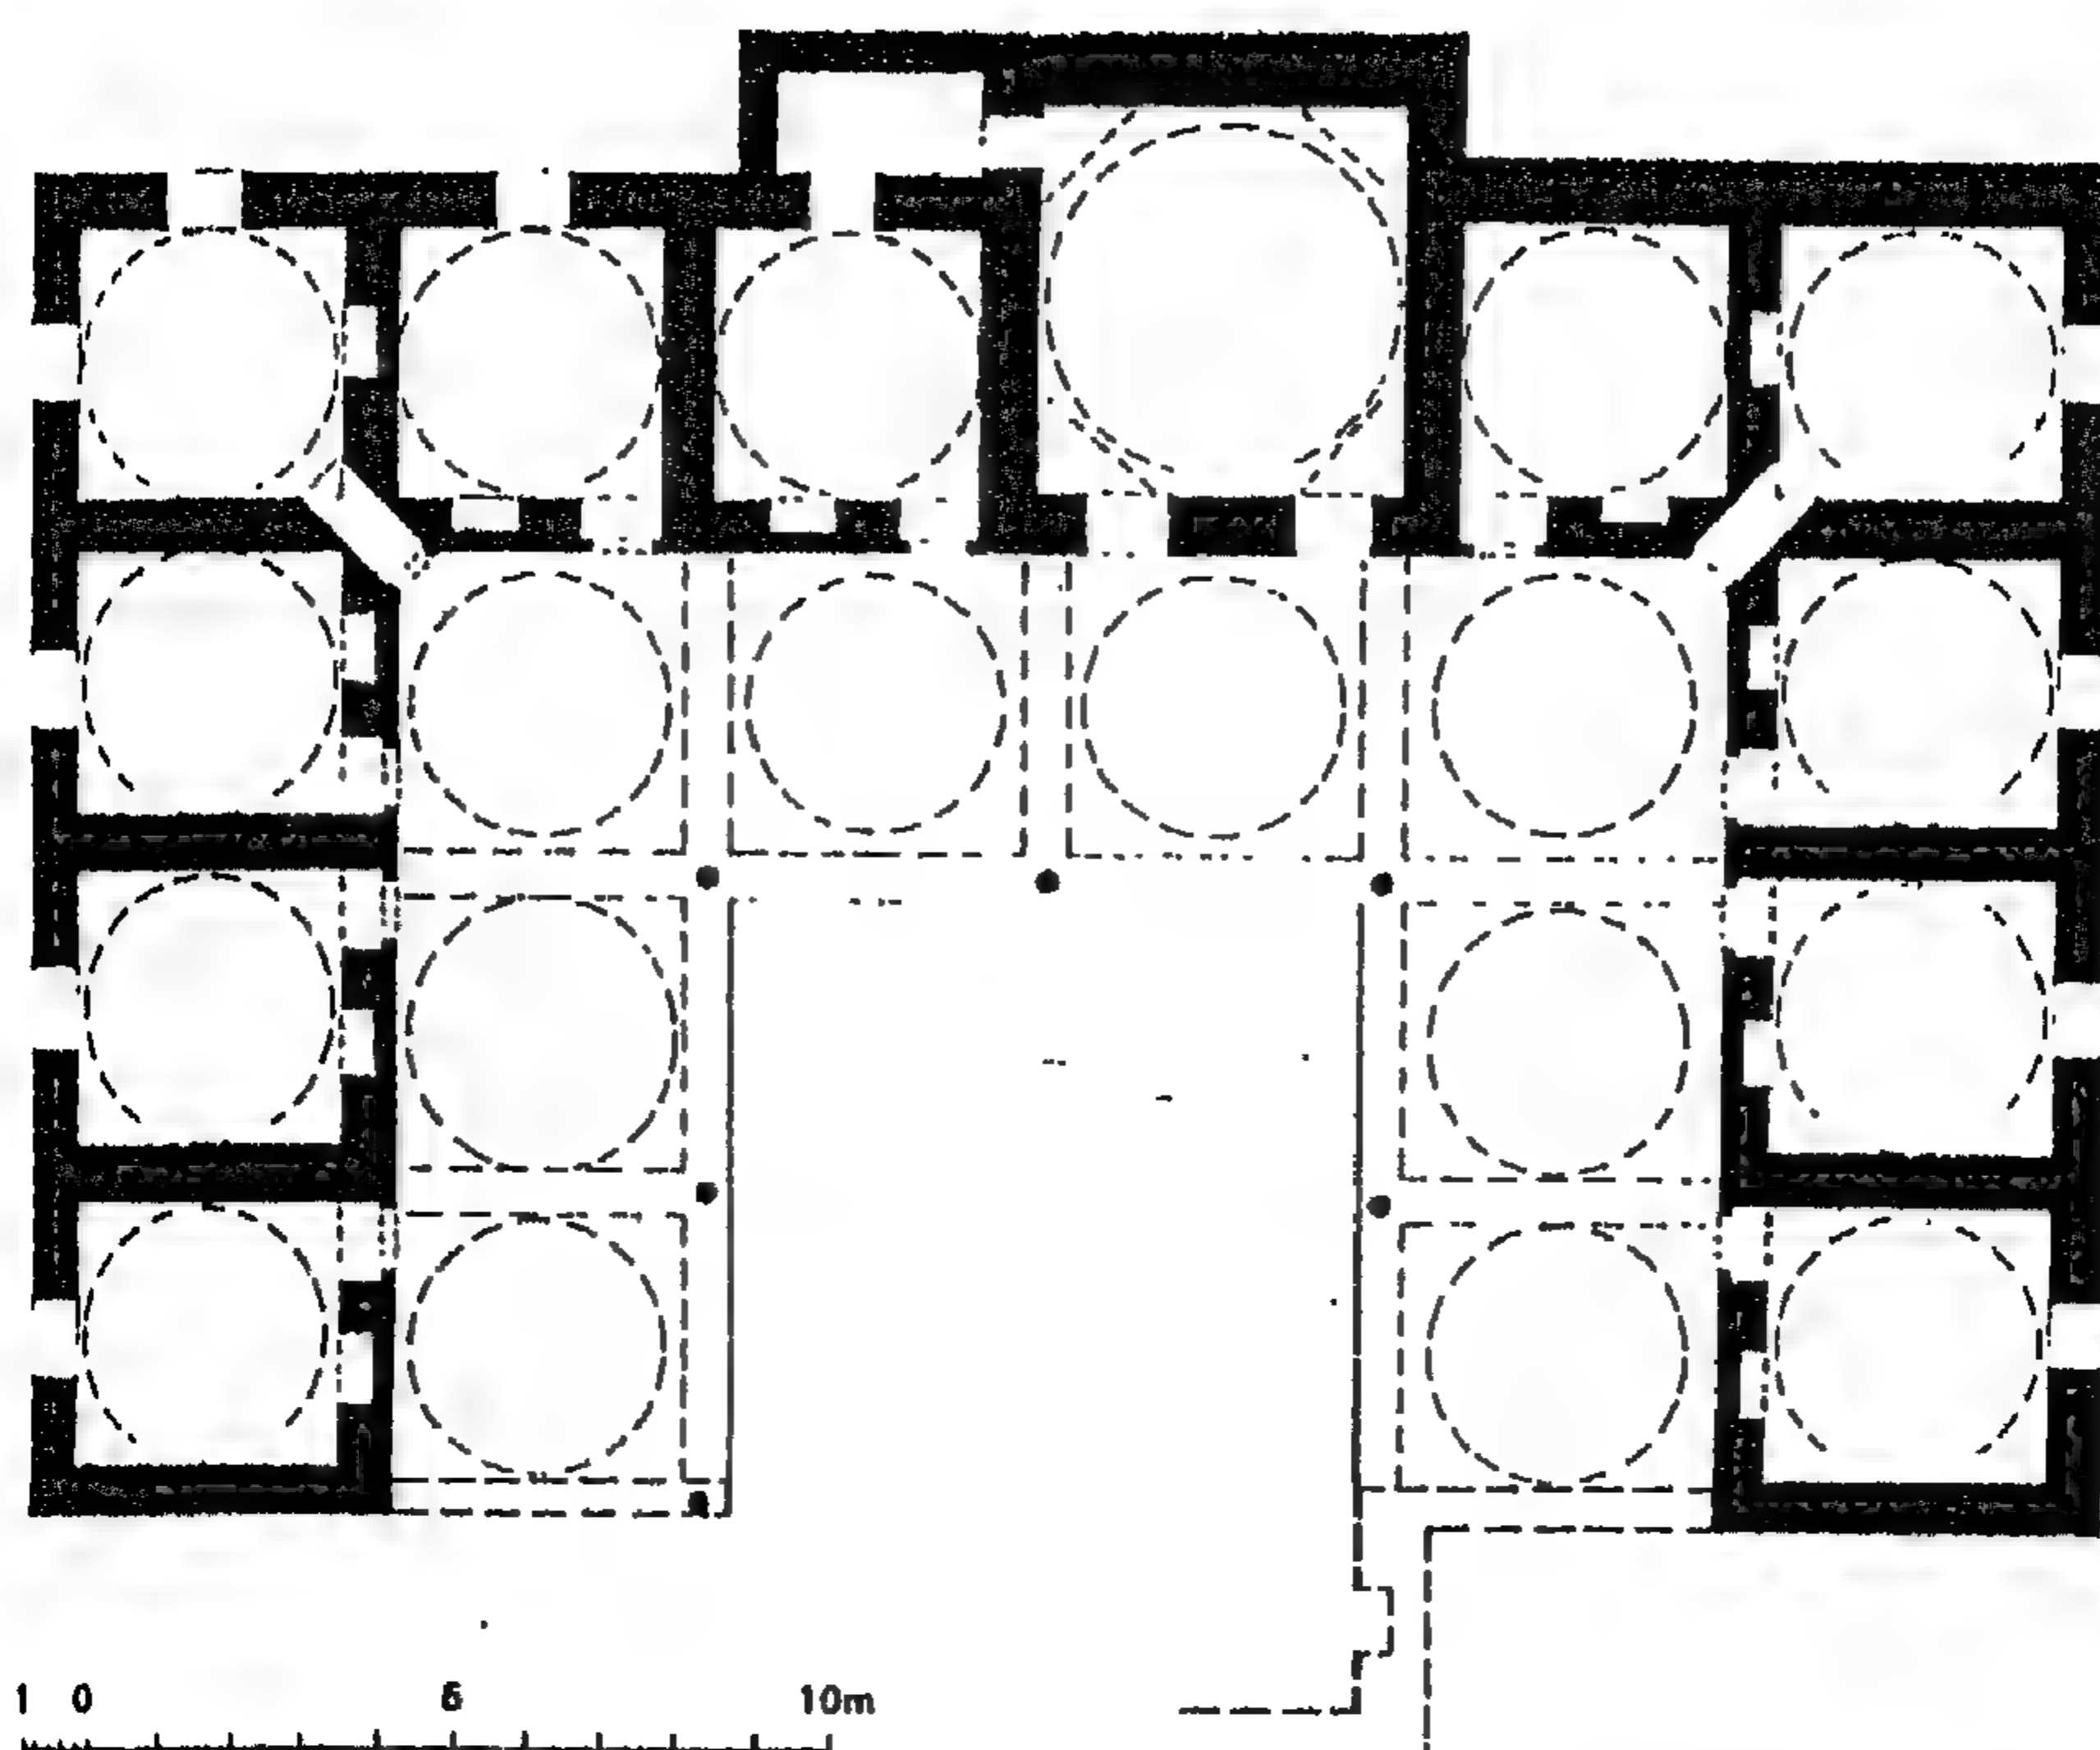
مسقط أفقي لمدرسة بايزيد
